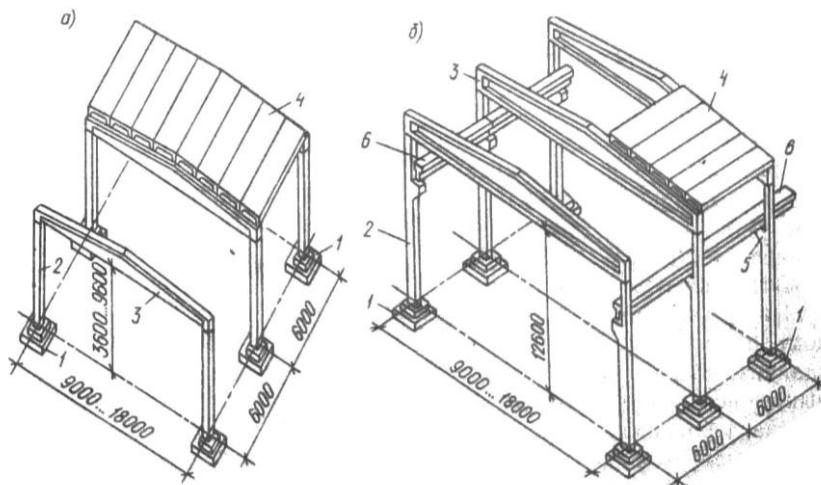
Конструктивные схемы унифицированных зданий систем водоснабжения и канализации при пролетах 9... 18 м:
